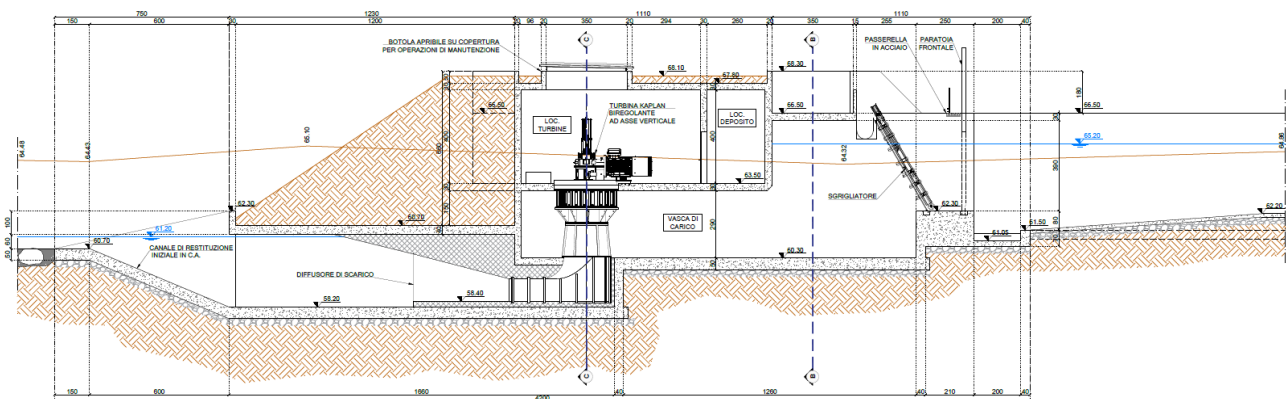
Sezione longitudinale dell'edificio di centrale in progetto (elaborato ELG204)
